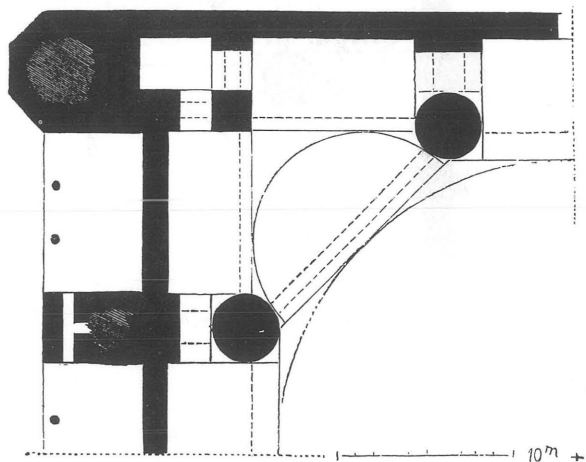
Mezquita de Andrinópolis, Constantinopla. Detalle de la planta
